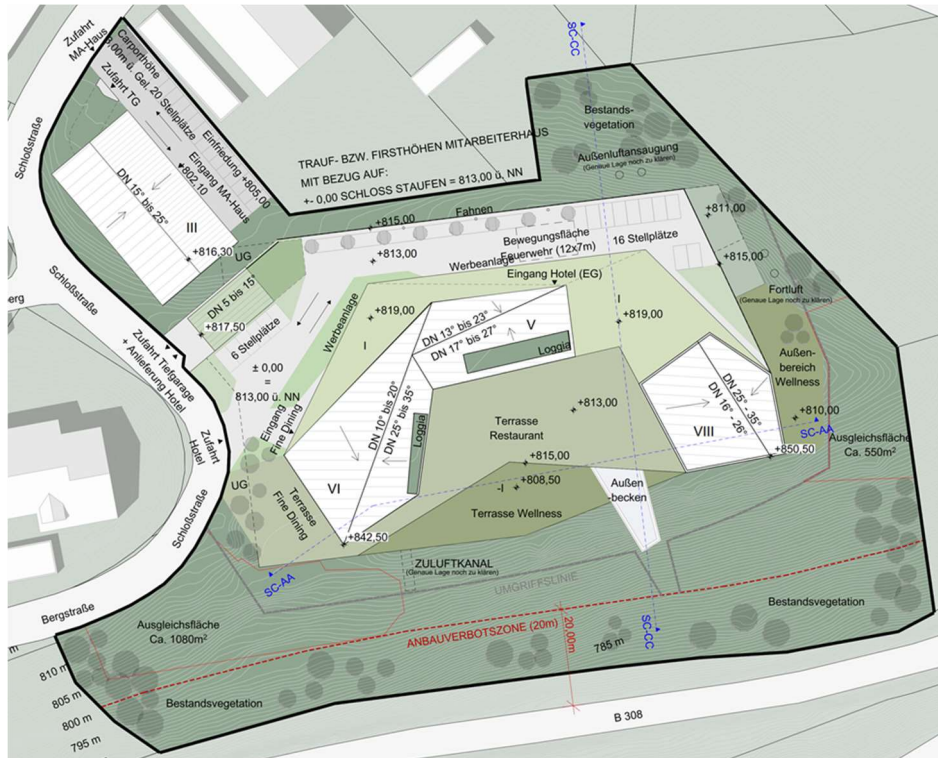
Lageplan mit Darstellung der geplanten räumlichen Anordnung der Gebäude [a]
